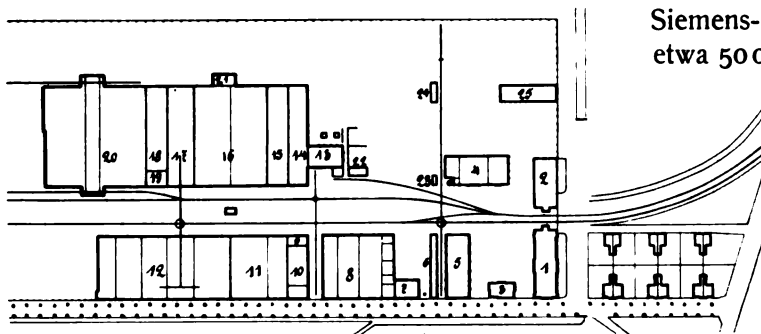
Maschinen-Bauanstalt Hohenzollern, Aktiengesellschaft. Lageplan.
